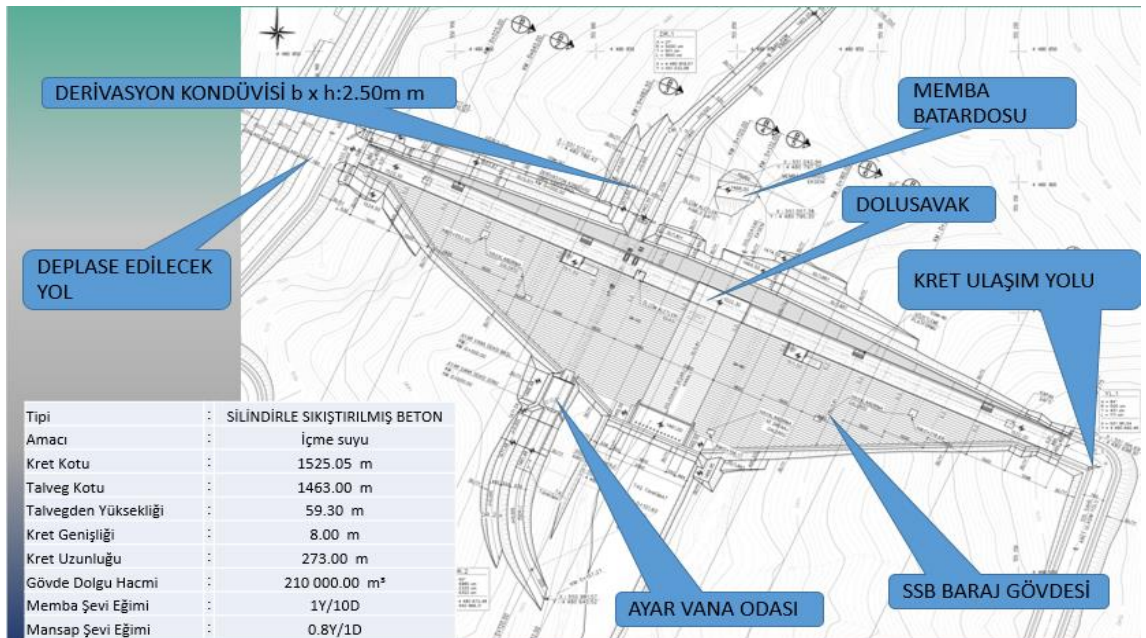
Bahçecik Barajı vaziyet planı (Sepa Mühendislik ve Müşavirlik 2016).
